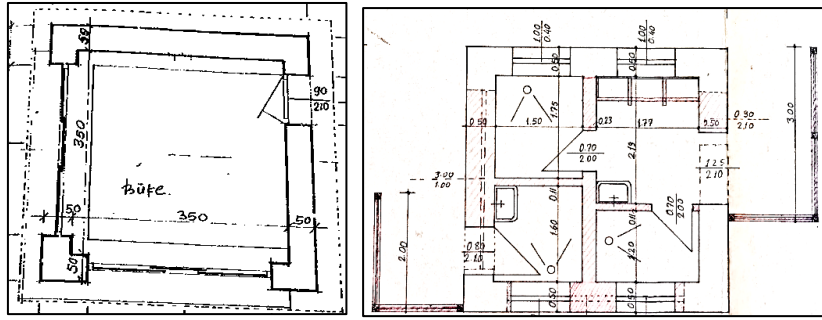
Prefabrik Yapıların Planı ve Cephesi (TCDD).
